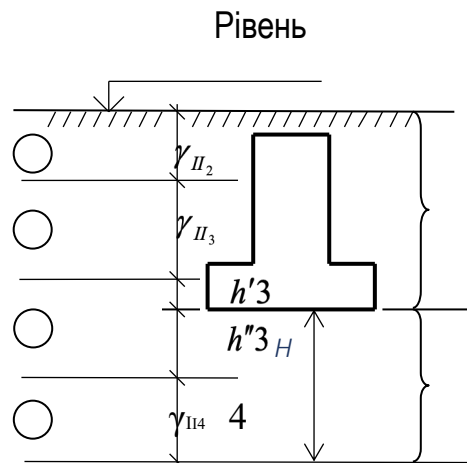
Схема для визначення питомої ваги ґрунтів, розташованих над і під подошвою фундаменту.
